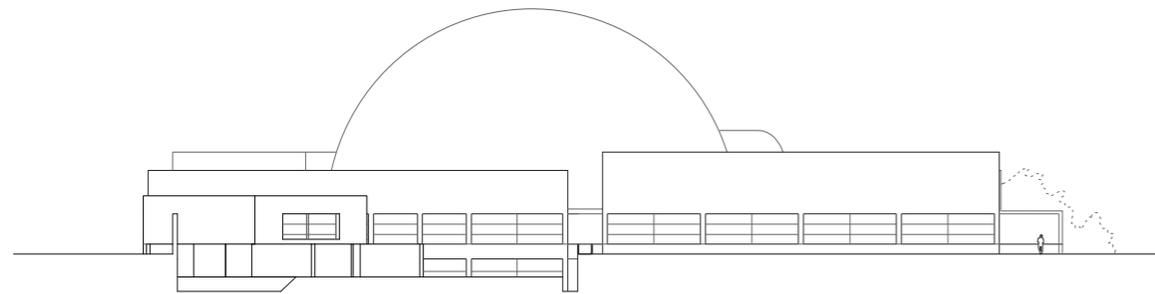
Alzado norte, desde la Görlitzer Straße.
